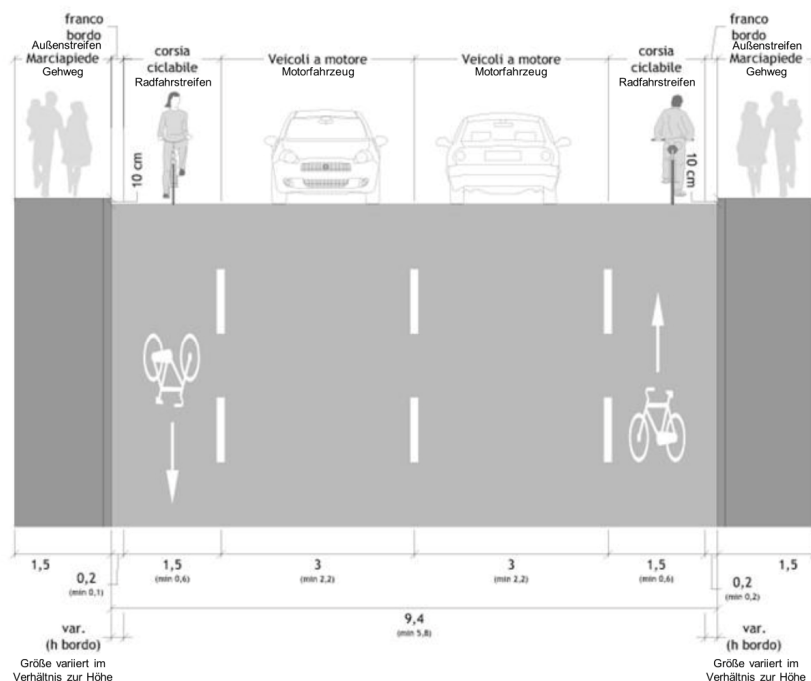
Vertikale Beschilderung und typologischer Abschnitt einer Straße mit Radweg
